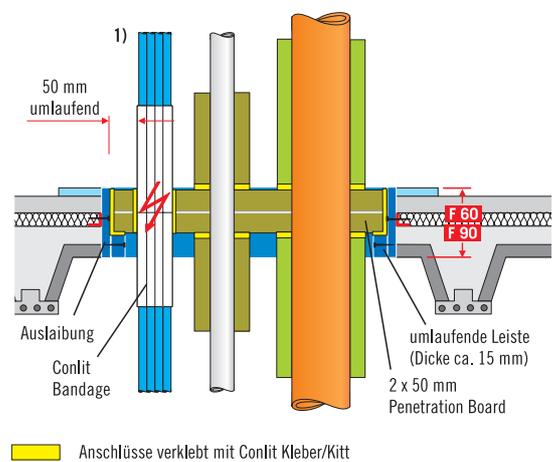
Beispiel einer Abschottung innerhalb einer Balkendecke mit Rockwool Penetration Board innerhalb einer eingemörtelten Auslaibung
